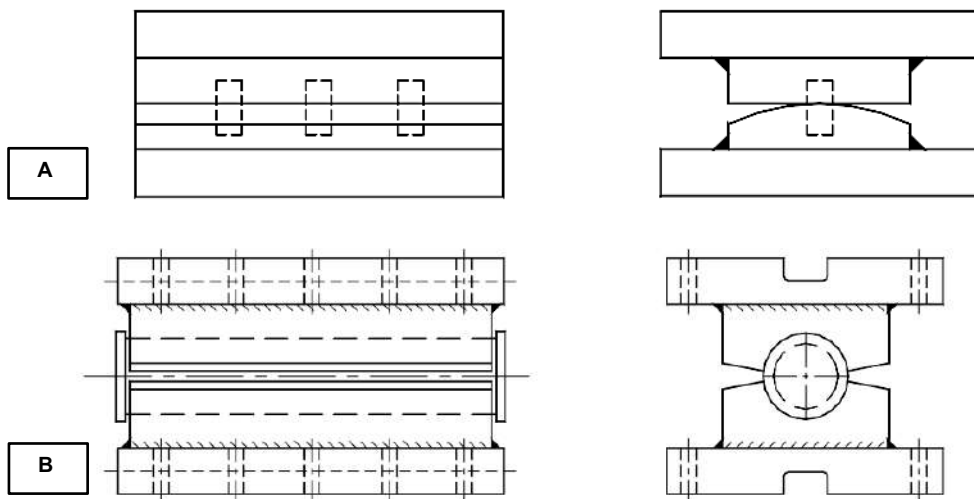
A. Apoio rotulado fixo sem rolo metálico. B. Apoio fixo com rolo metálico. Fonte: DNIT, 2004
